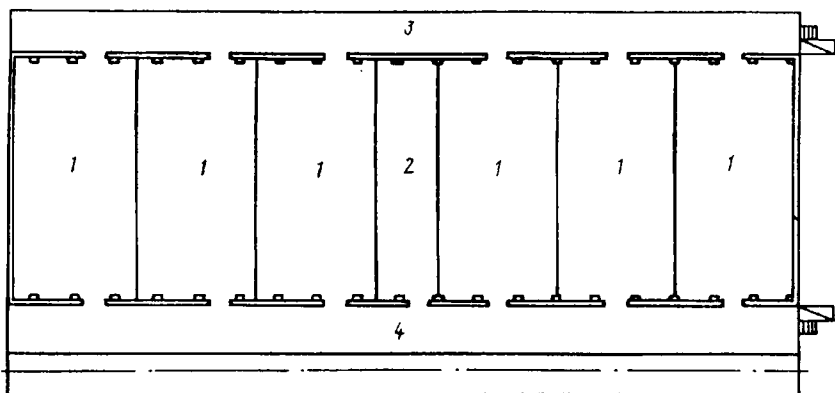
Бескоридорная планировка одноэтажного холодильника:
